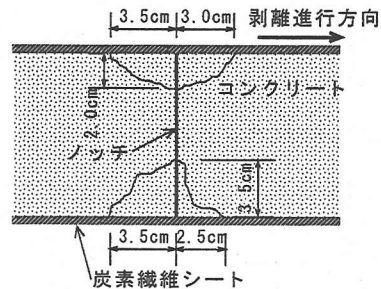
ノッチ部ひび割れ状況 (No.1-4 ②)
